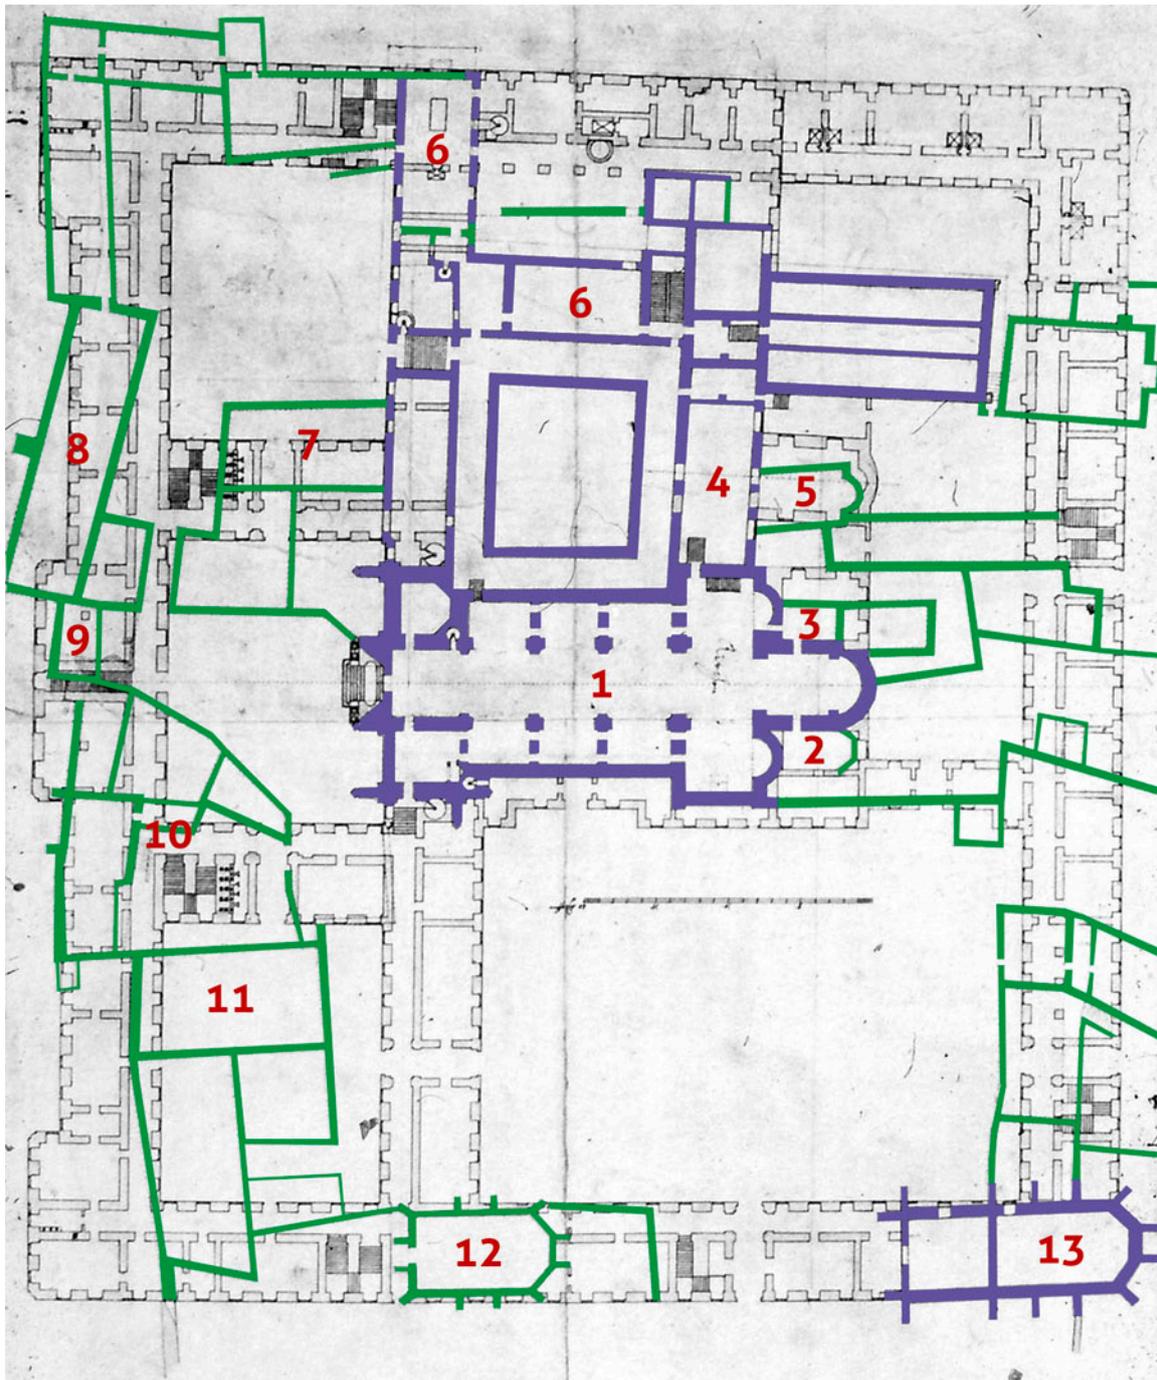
Jakob Prandtauer, Erdgeschoss-Grundriss für den Umbau mit eingezeichnetem Altbestand, 1714–15, Stiftsarchiv Klosterneuburg Pz. 1.
